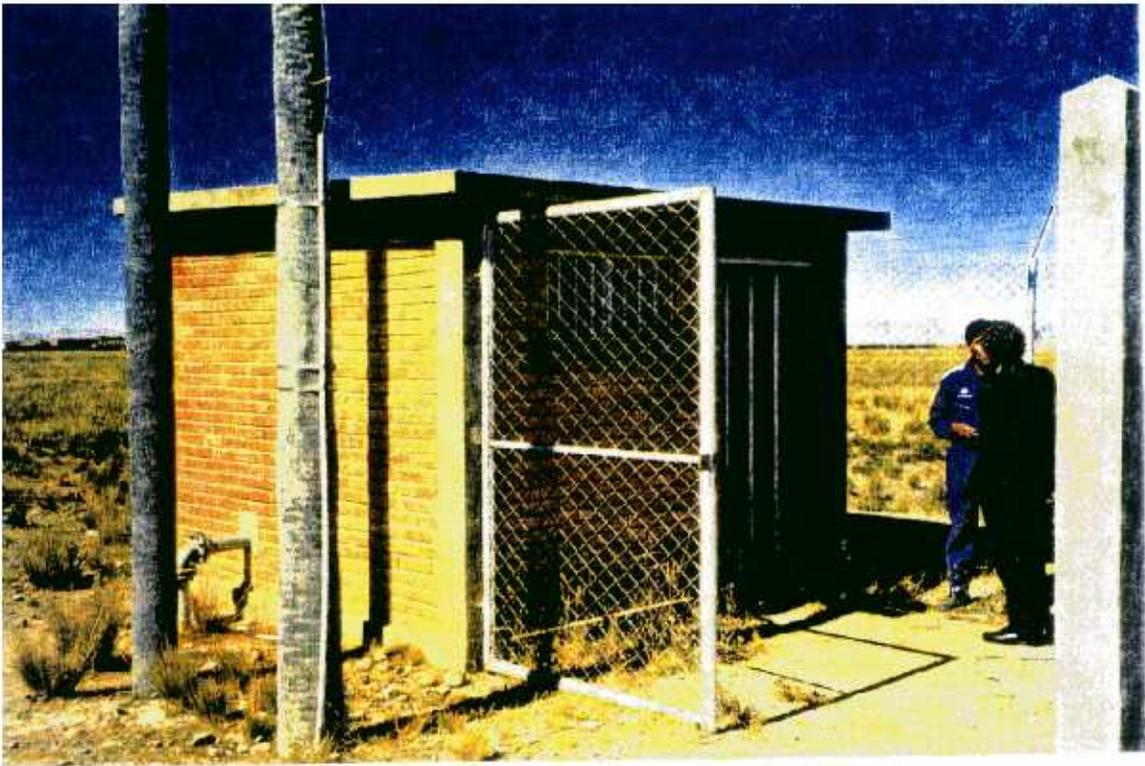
Caseta de Pozo. Planta Tilata. junio 1998
